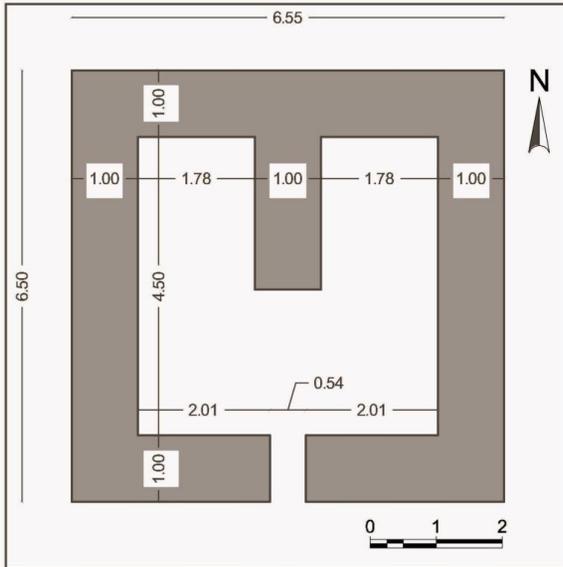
أطم (حصن) الخشاشة: مسقط أفقي
